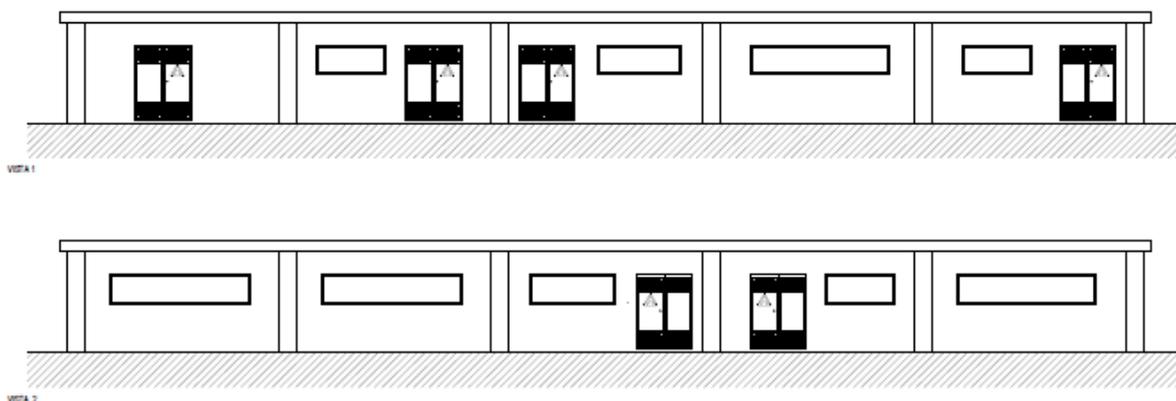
Viste in pianta e prospetto cabina di smistamento
